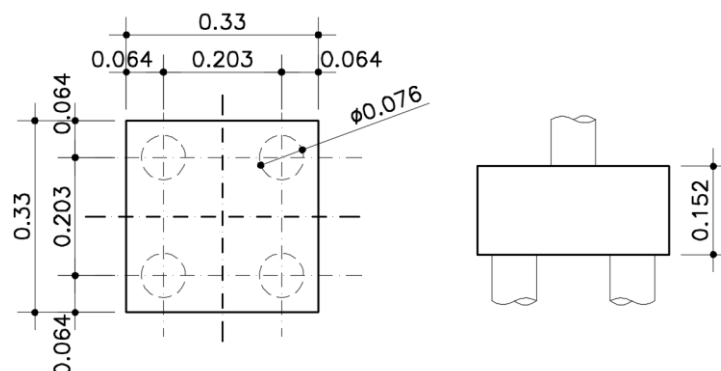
Vista em planta e elevação do bloco ensaiado por Sabnis e Gogate (1984), com dimensões em metros
